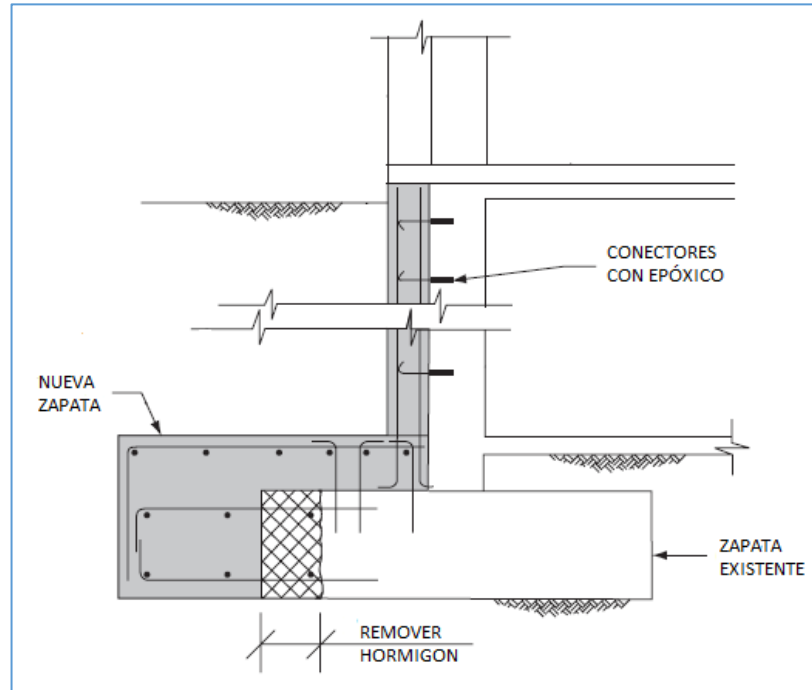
Detalle de recrecimiento de zapatas de hormigón
